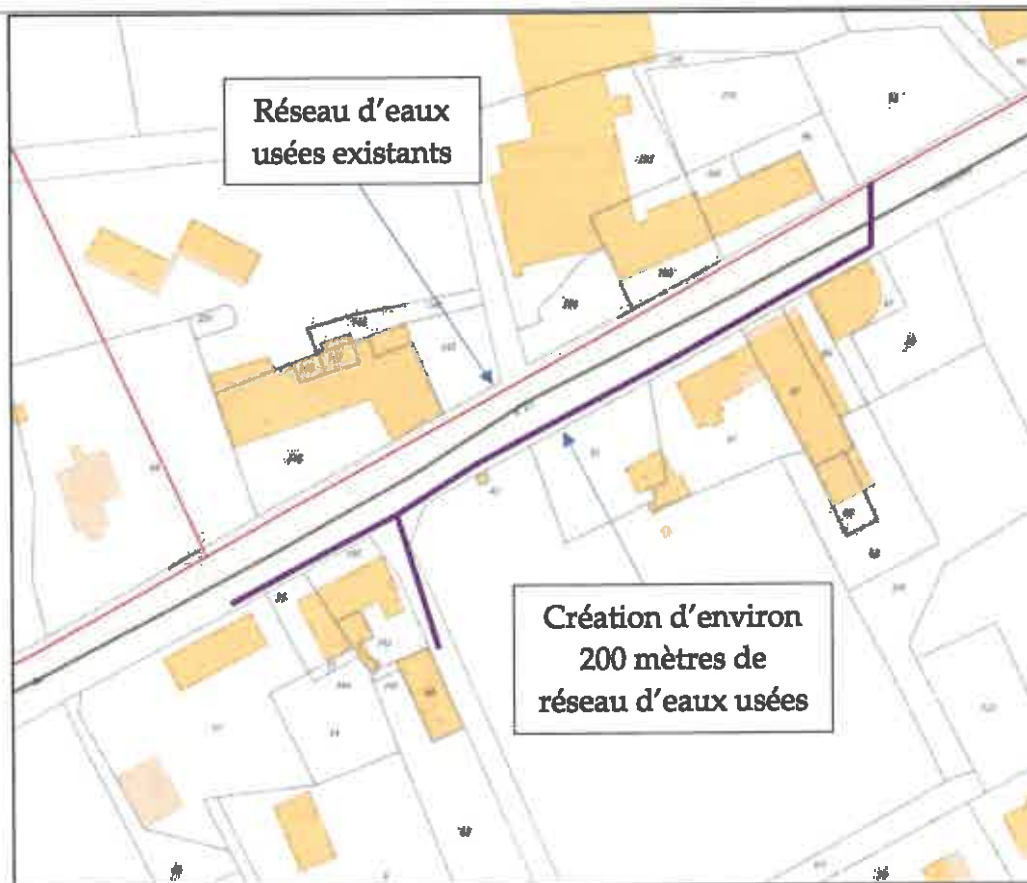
Projet de raccordement des Betouilles Sud sur le réseau d'assainissement collectif existant
